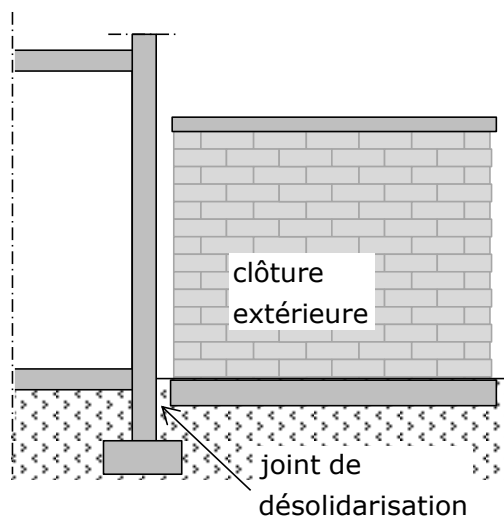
exemple de désolidarisation des fondations des ouvrages secondaires
